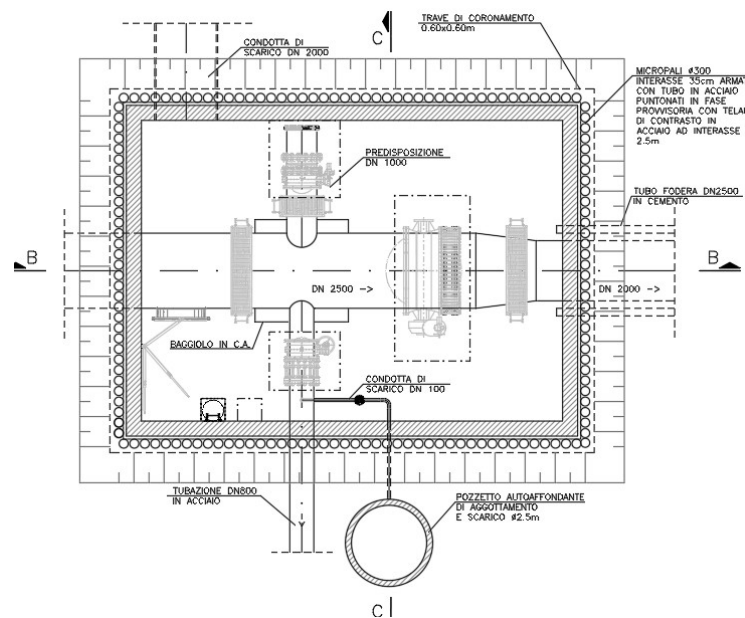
Pianta e sezione del manufatto Casal del Marmo.
